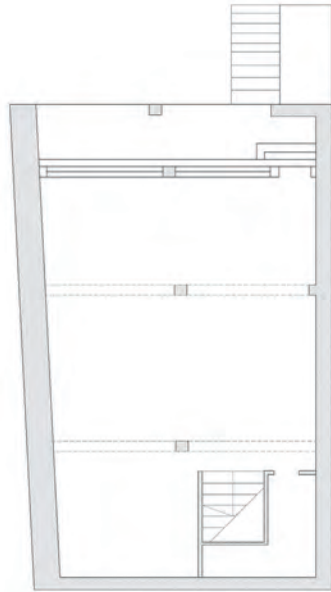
7. 1992 PLANTA SEMISÓTANO
